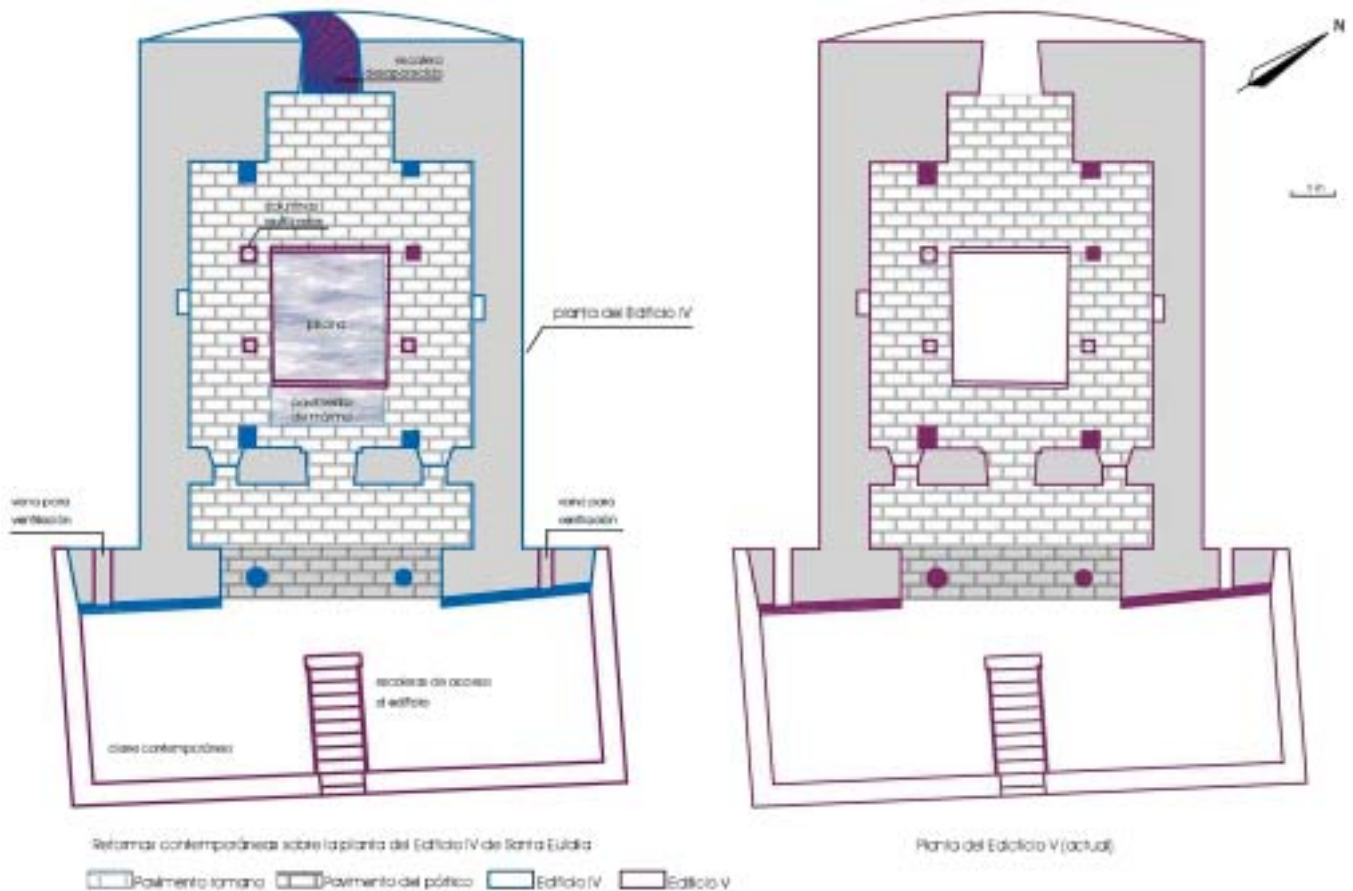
A la izquierda: reformas contemporáneas sobre la planta del *Edificio IV* de Santa Eulalia de Bóveda; a la derecha: planta del *Edificio V* (actual) de Santa Eulalia de Bóveda
